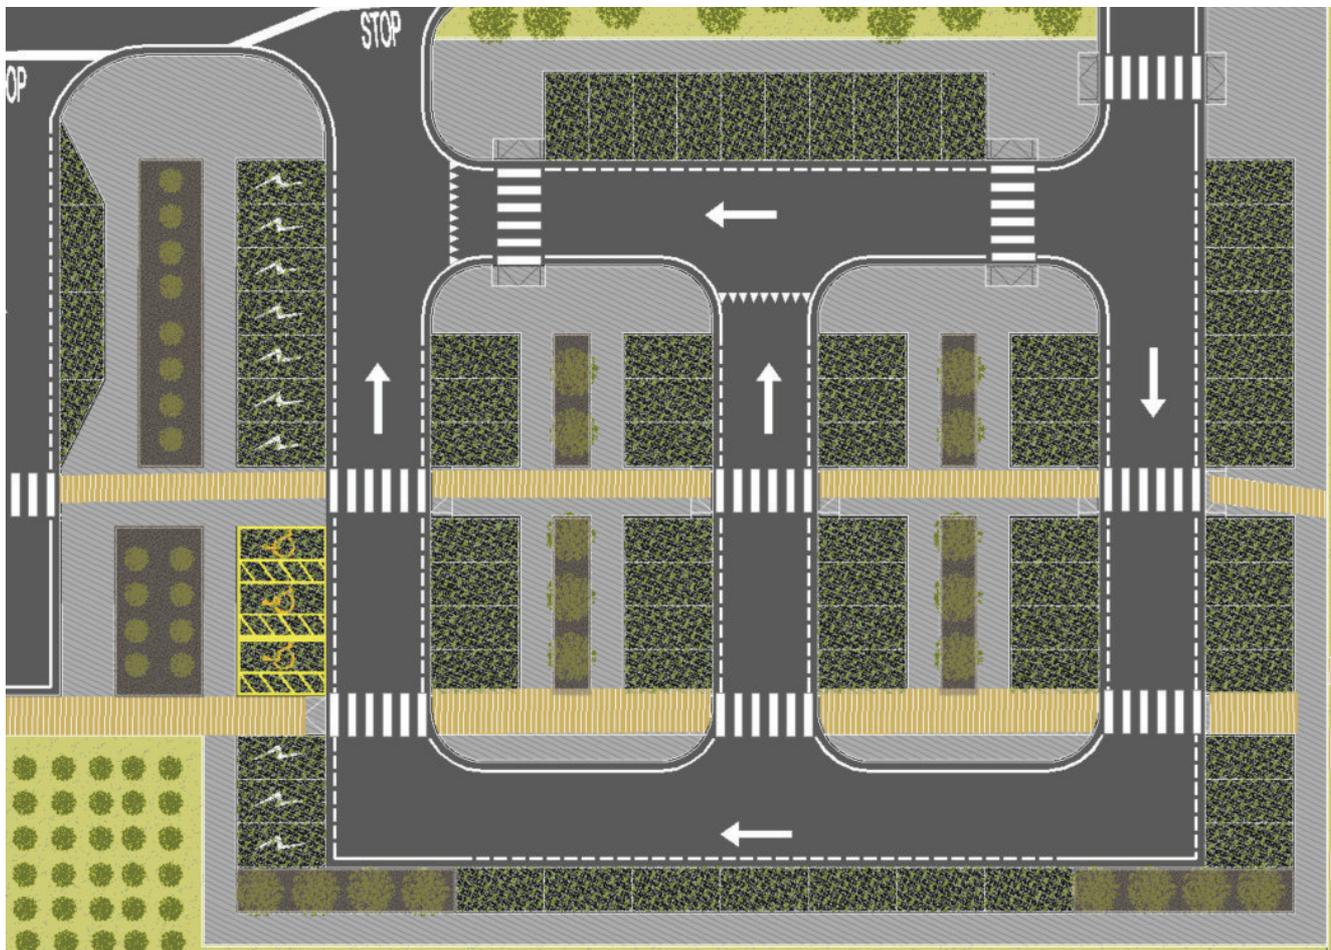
Piazzale di stazione con pavimentazione in masselli autobloccanti
